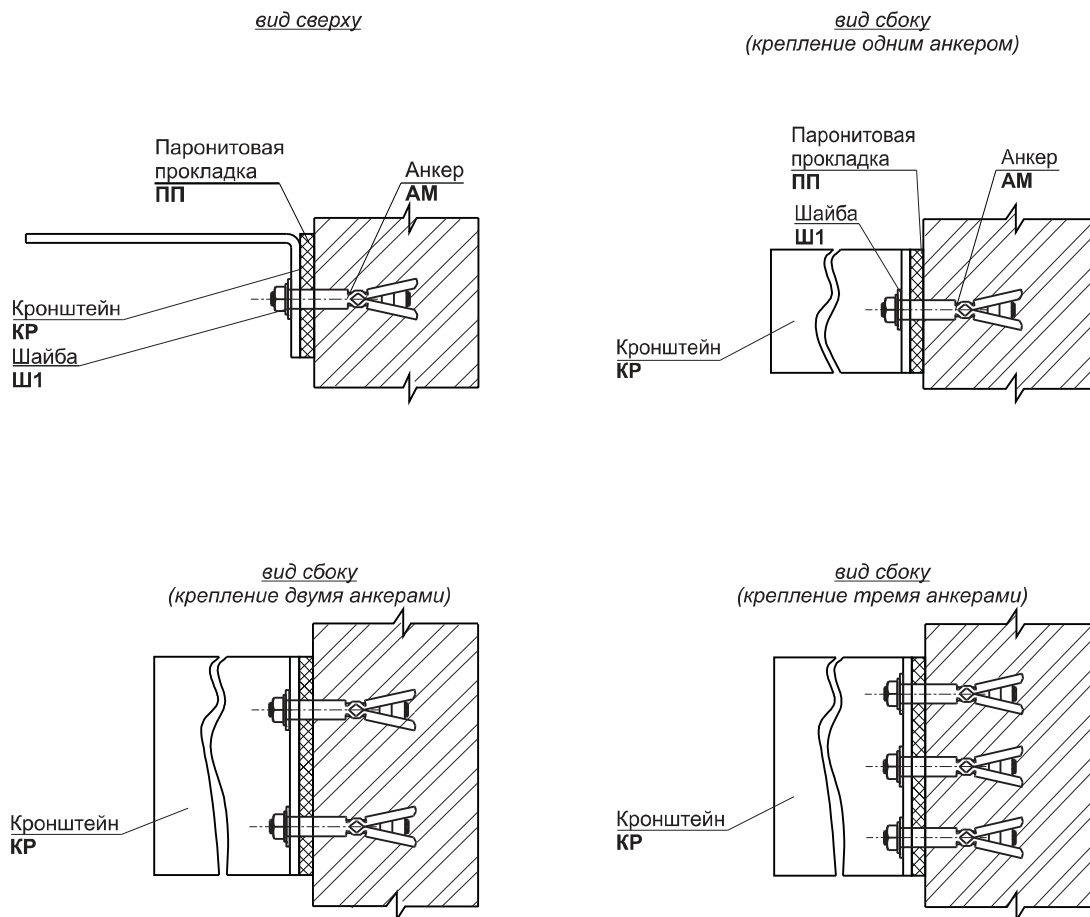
Узел крепления кронштейна КР, КРУ (исполнение 1) к стене.
